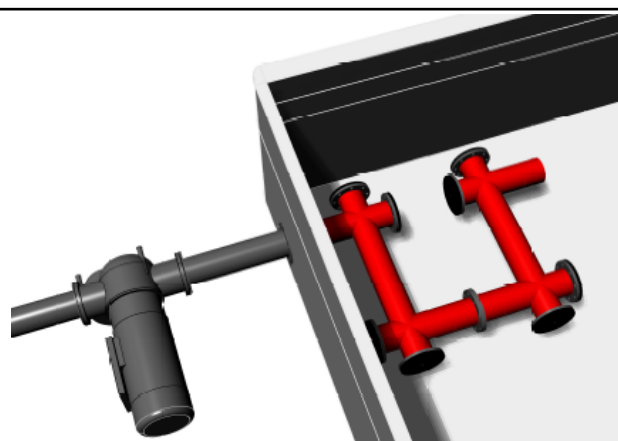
Installazione Interna al serbatoio per Sistema UltraLED Water 2000/2 (disegno stilizzato)
